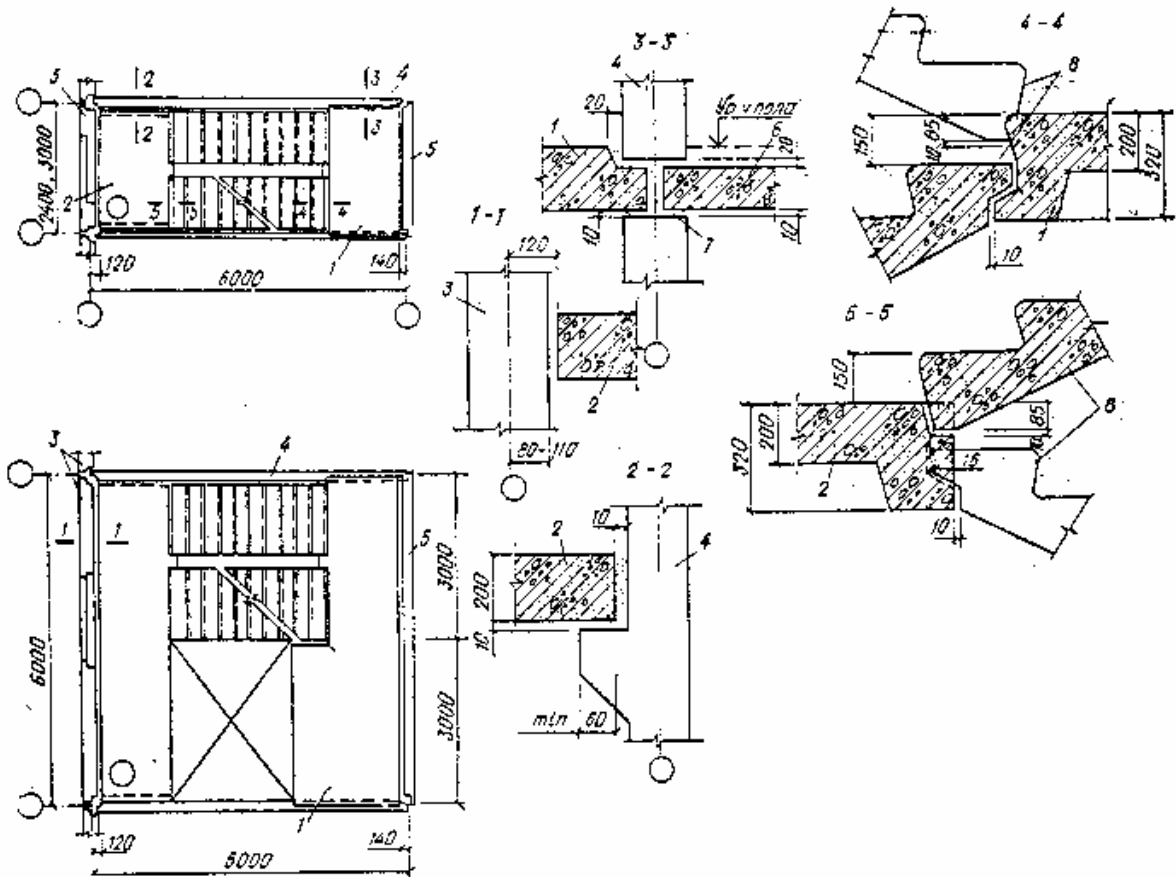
Примеры монтажных схем и узлов лестничных клеток в панельных бескаркасных зданиях:
